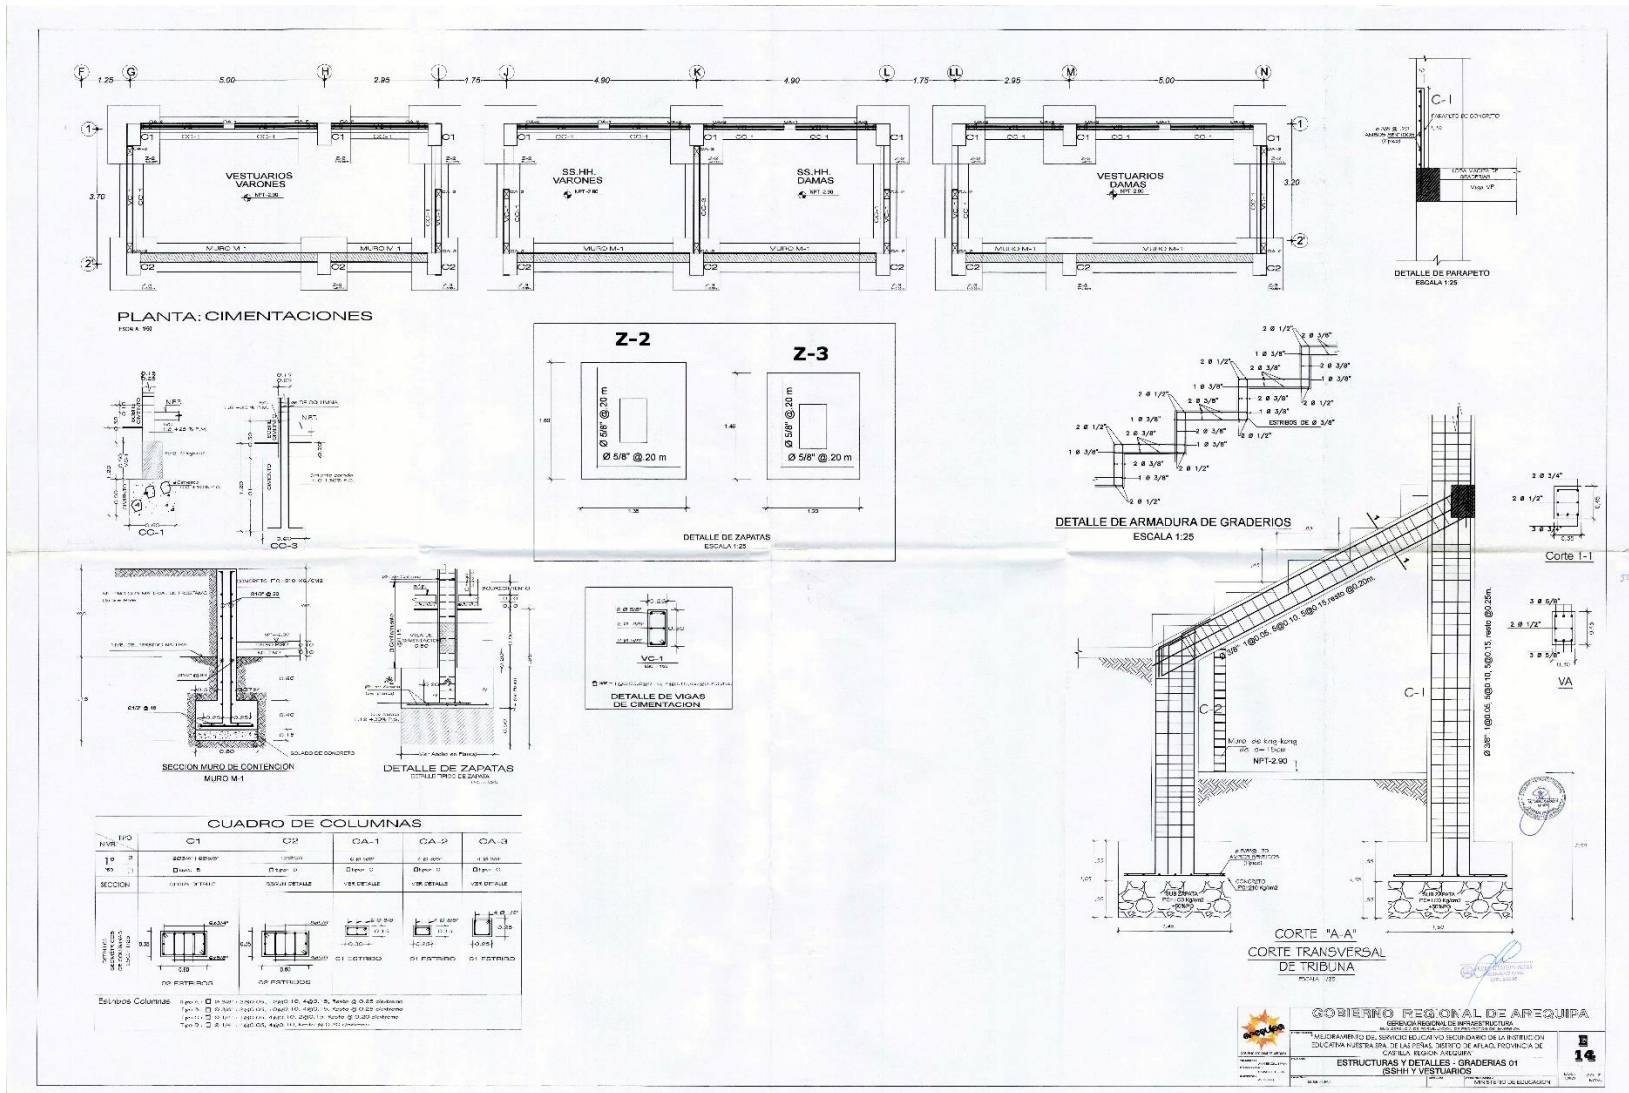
Plano de estructura – Planta gradería 01 del bloque 06 losa deportiva.
